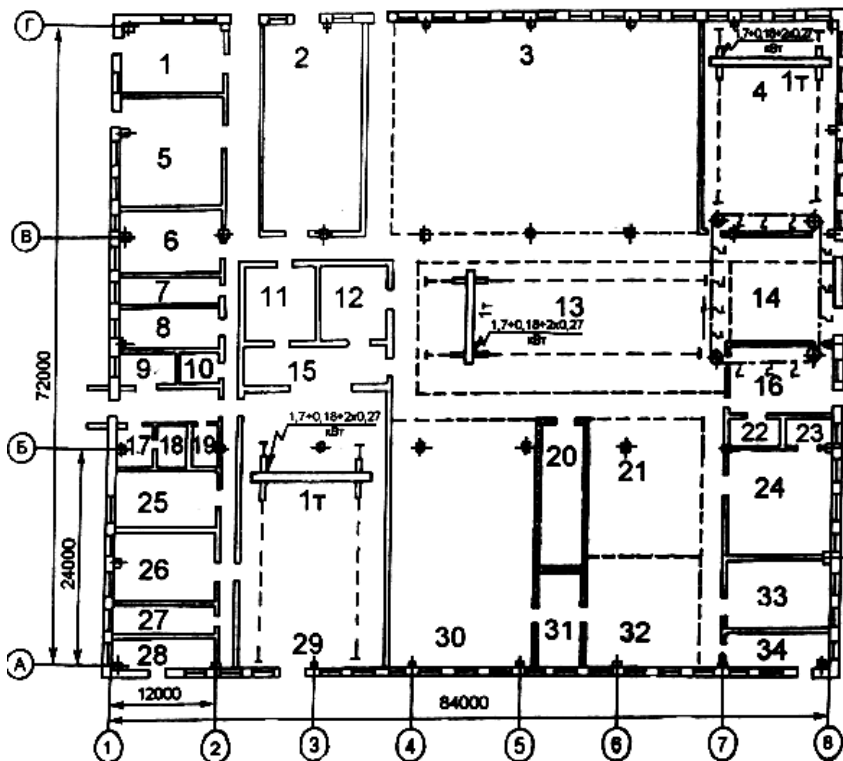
Нанесение размеров и координатной сетки на чертеж планировки производственного корпуса
